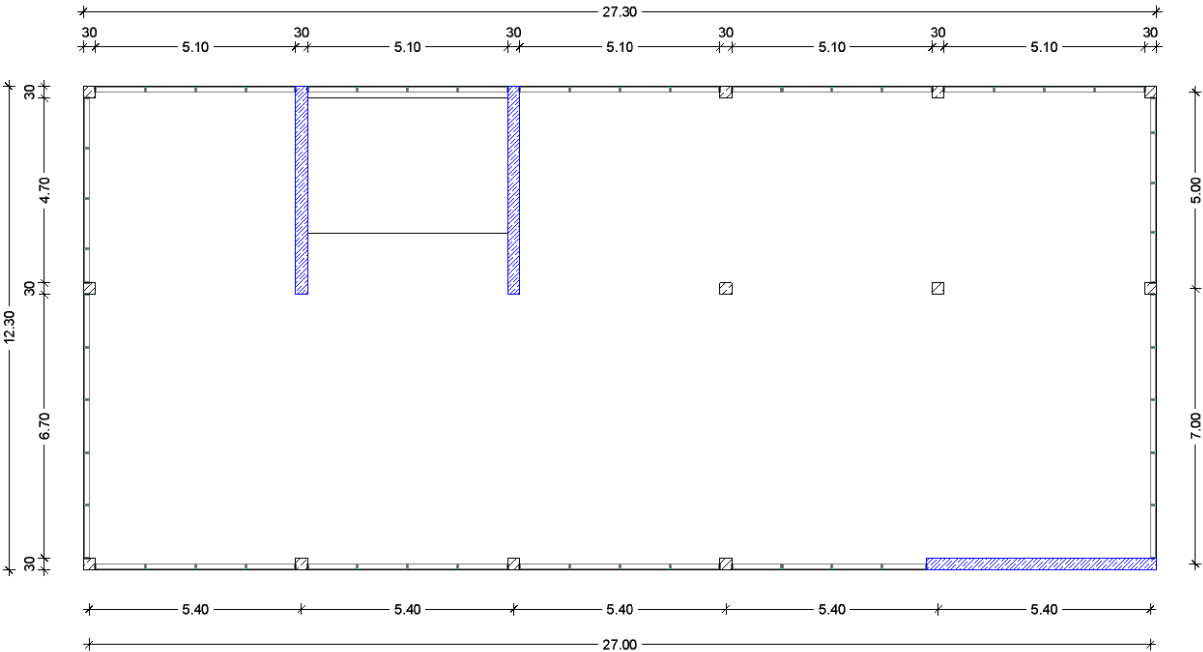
Grundriss: Regelgeschoss [44]
